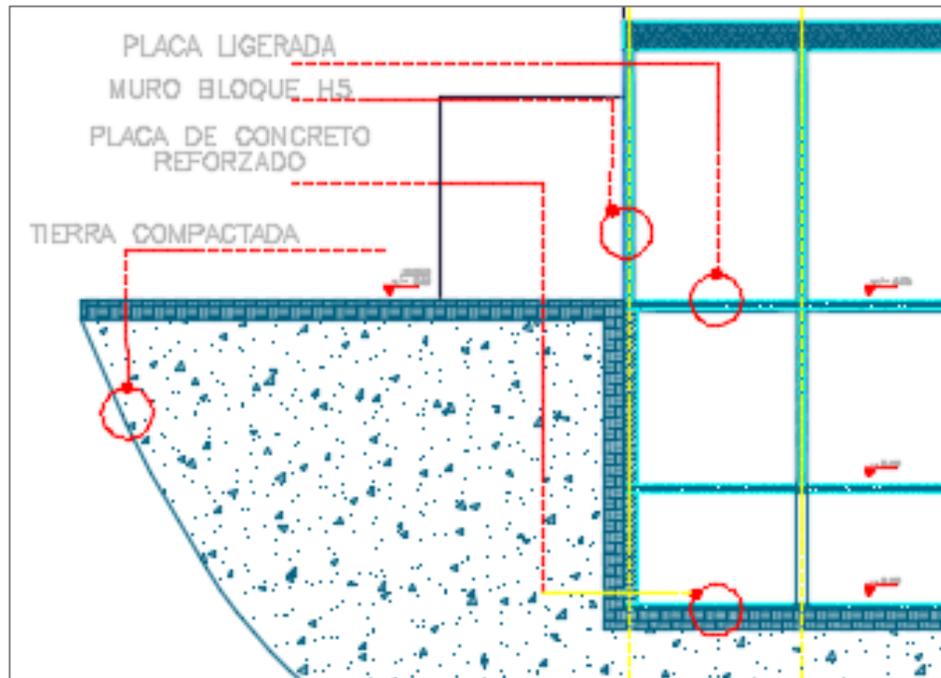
Corte fachada detalles constructivo (Rubiano, 2020)
